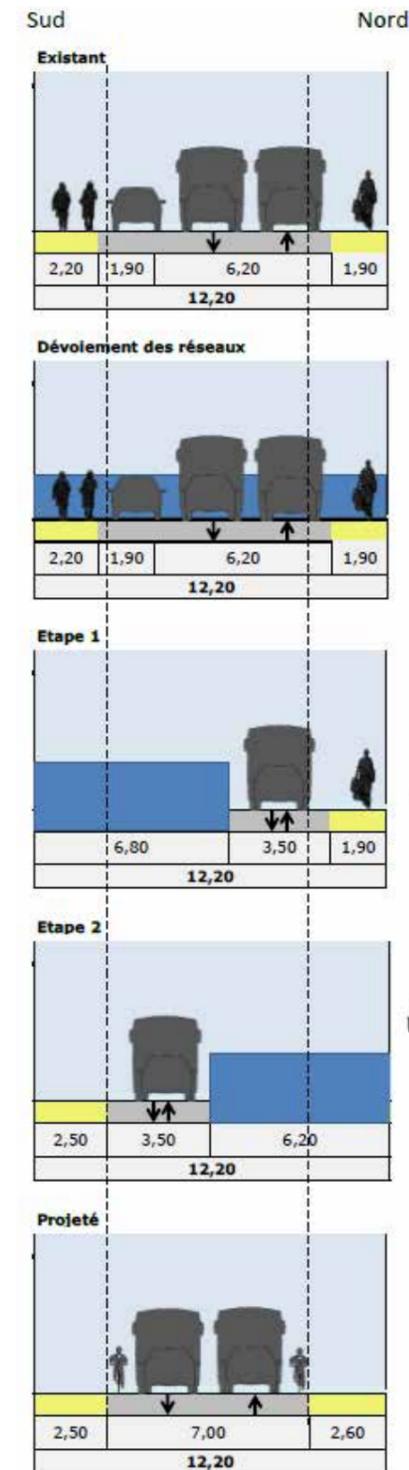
Coupe du phasage des travaux sur le boulevard Léon Feix
